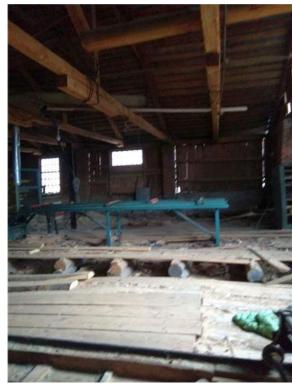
Здание лесопильного и малярного цеха,лит.И,и,и1,и2 (5)
